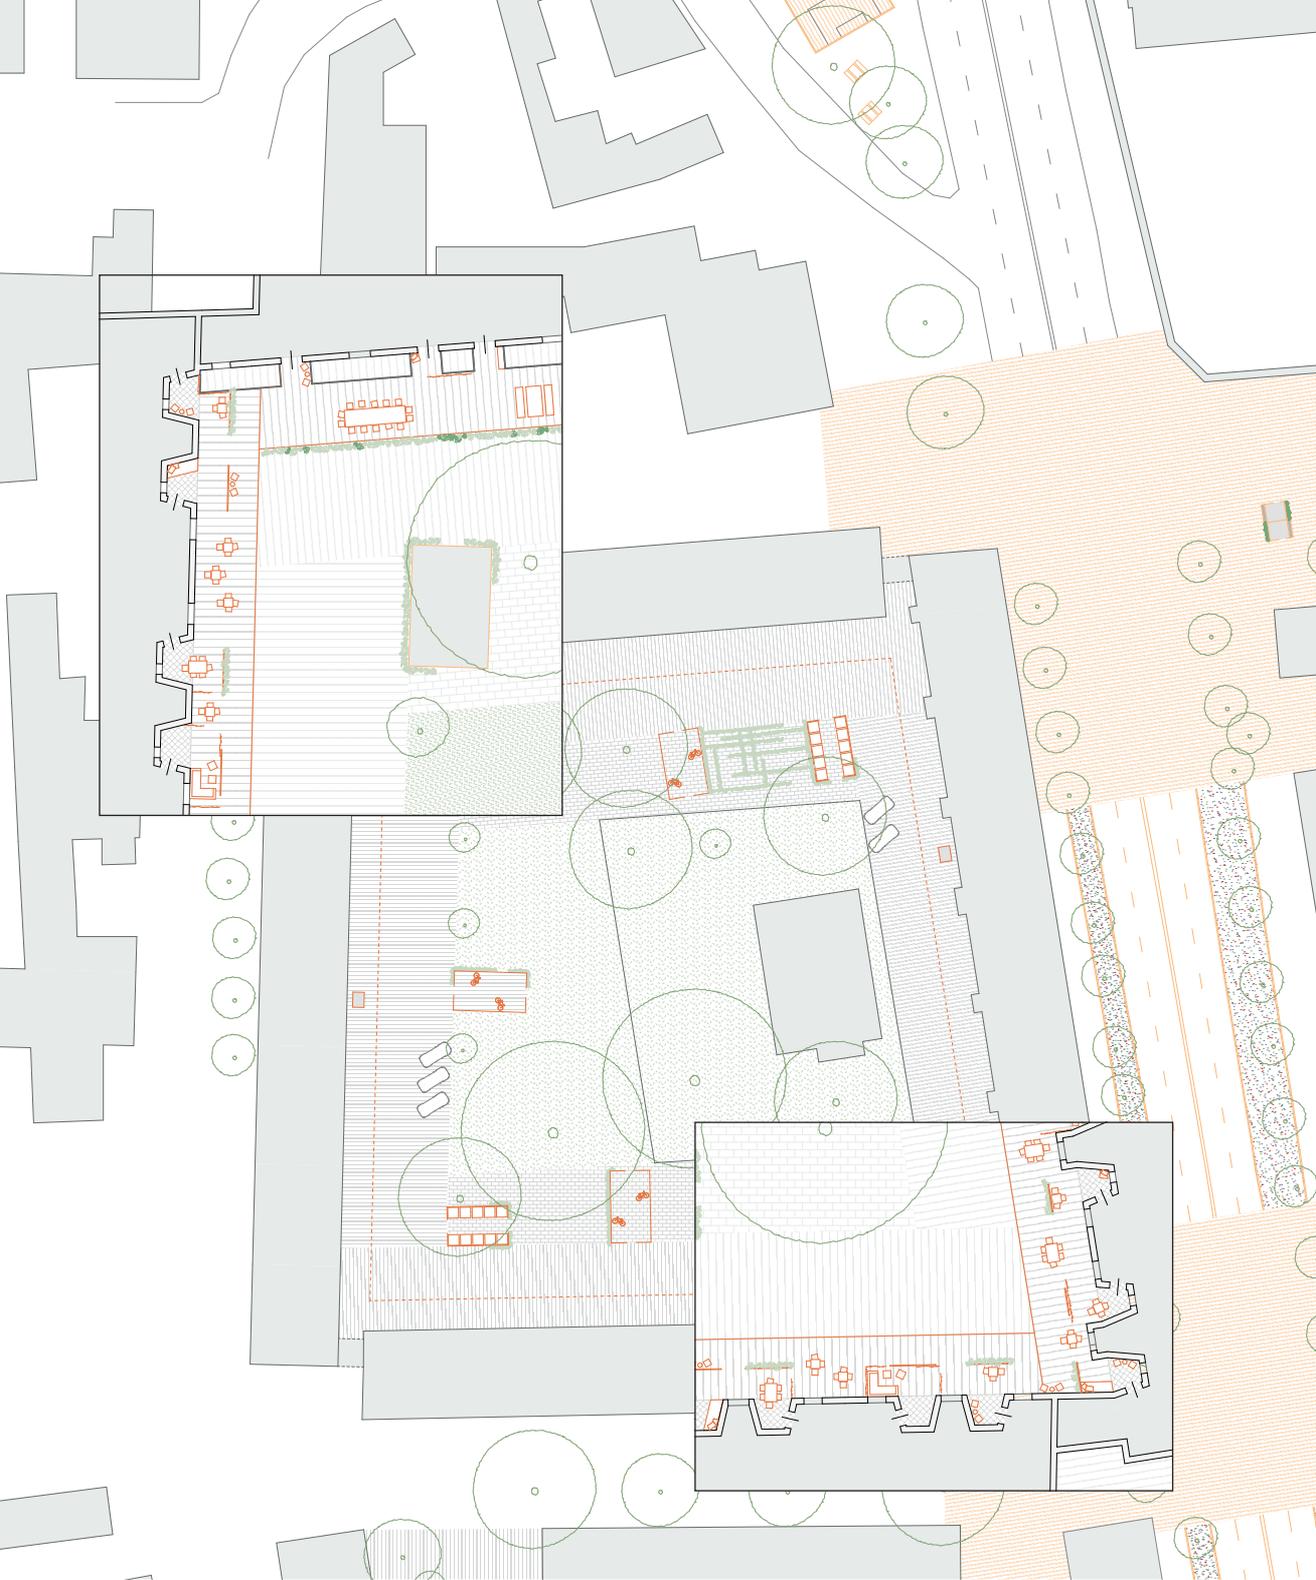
Grundriss Ebene 1 Terrassengemeinschaft
